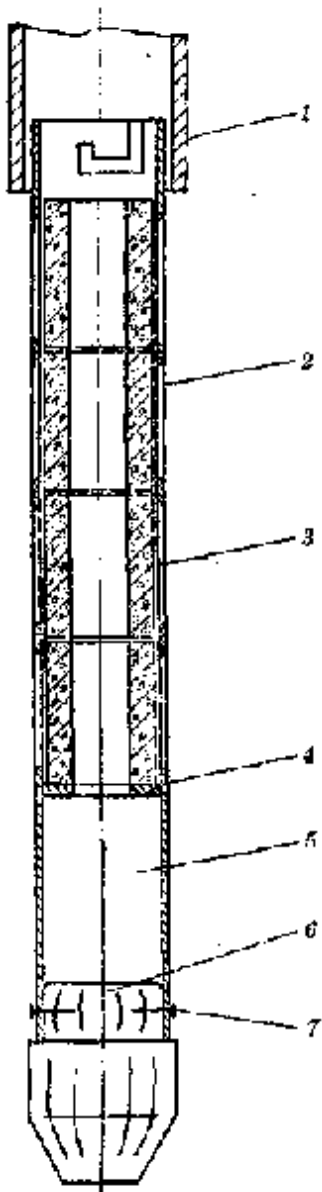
Сетчатый фильтр: 1 — штыковая муфта; 2 — сальник; 3 — отверстия; 4 — проволока; 5 — сетка; 6 — отстойник; 7 — пробка
